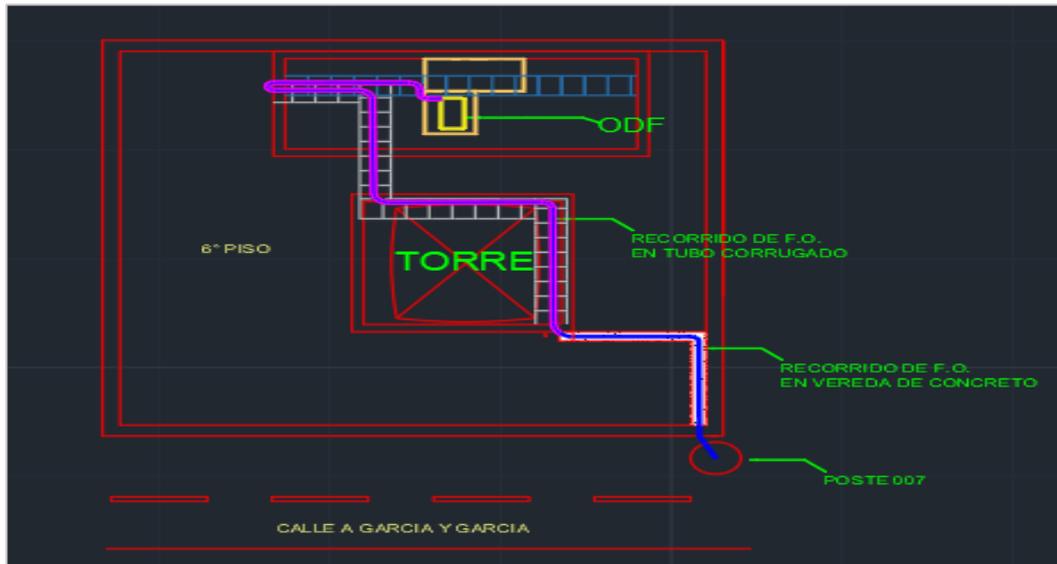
Plano de planta del recorrido del cable y equipo a instalar (ODF) en site San Marcos.
